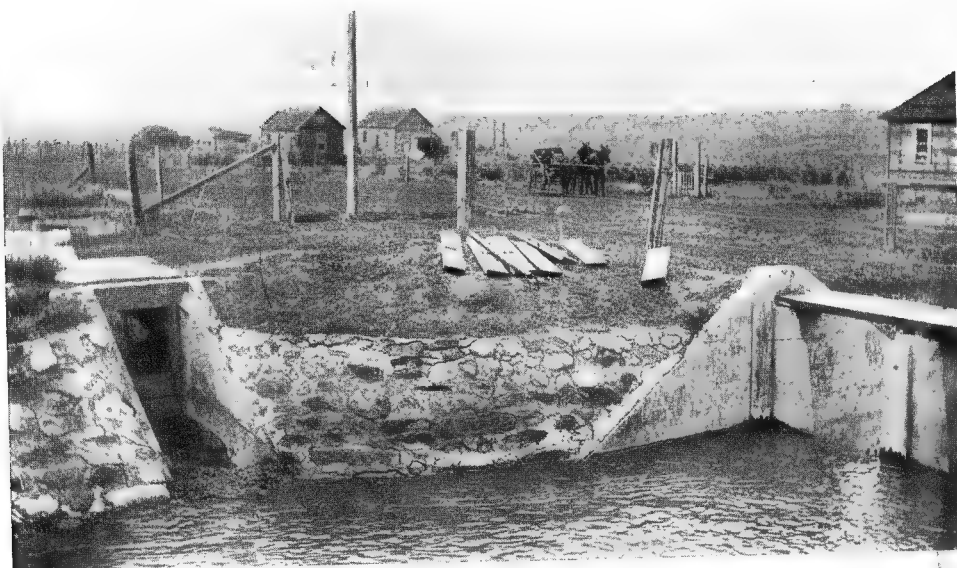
Жельзо-бетонные выпускъ и перепадъ на оросительномъ каналѣ
